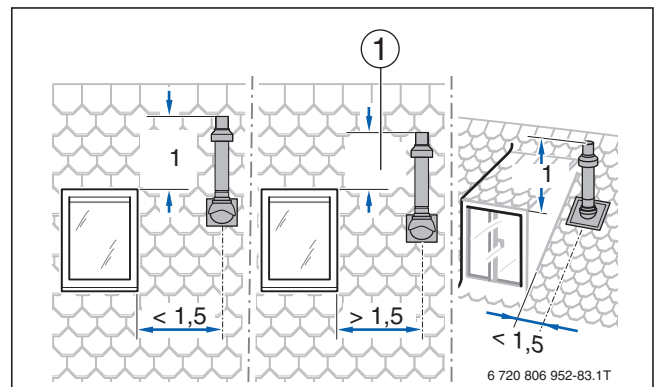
Mindestabstände zu Fenstern beim Bausatz DO (Maße in m)
